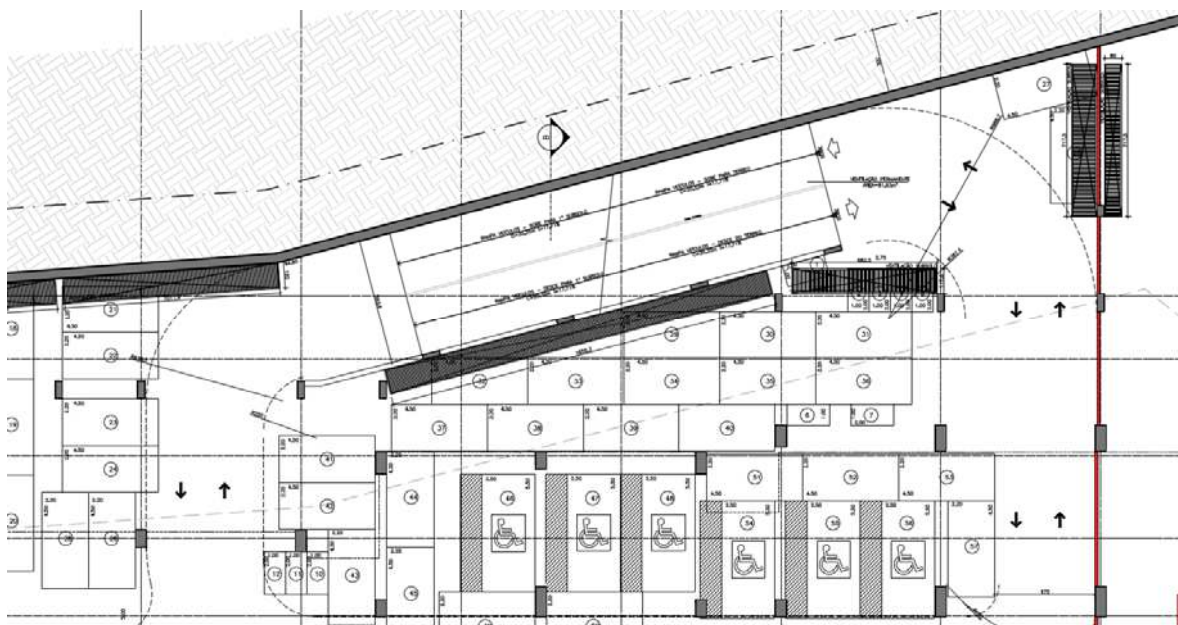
Planta do 1º Subsolo - Detalhe da rampa de acesso.
